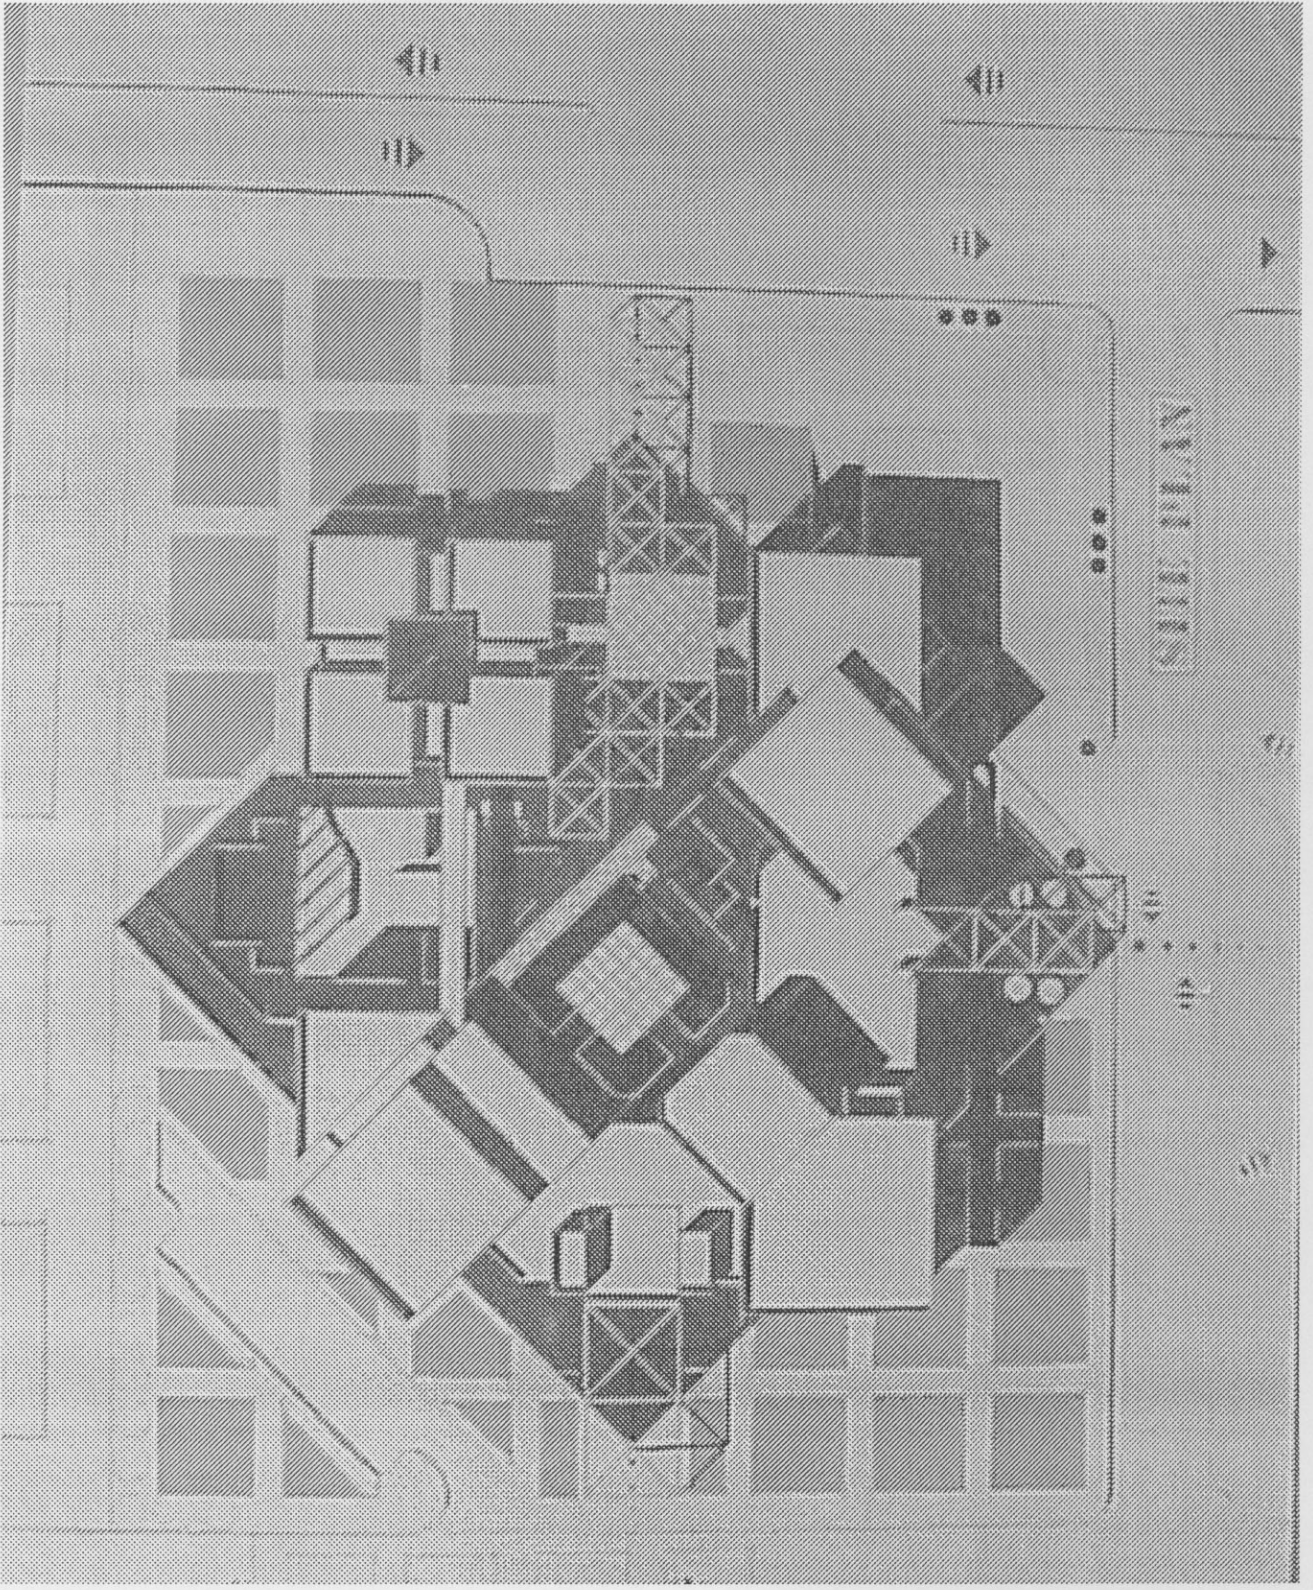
مسقط الطابق الأرضي (دخول خلفي وجانبي)
